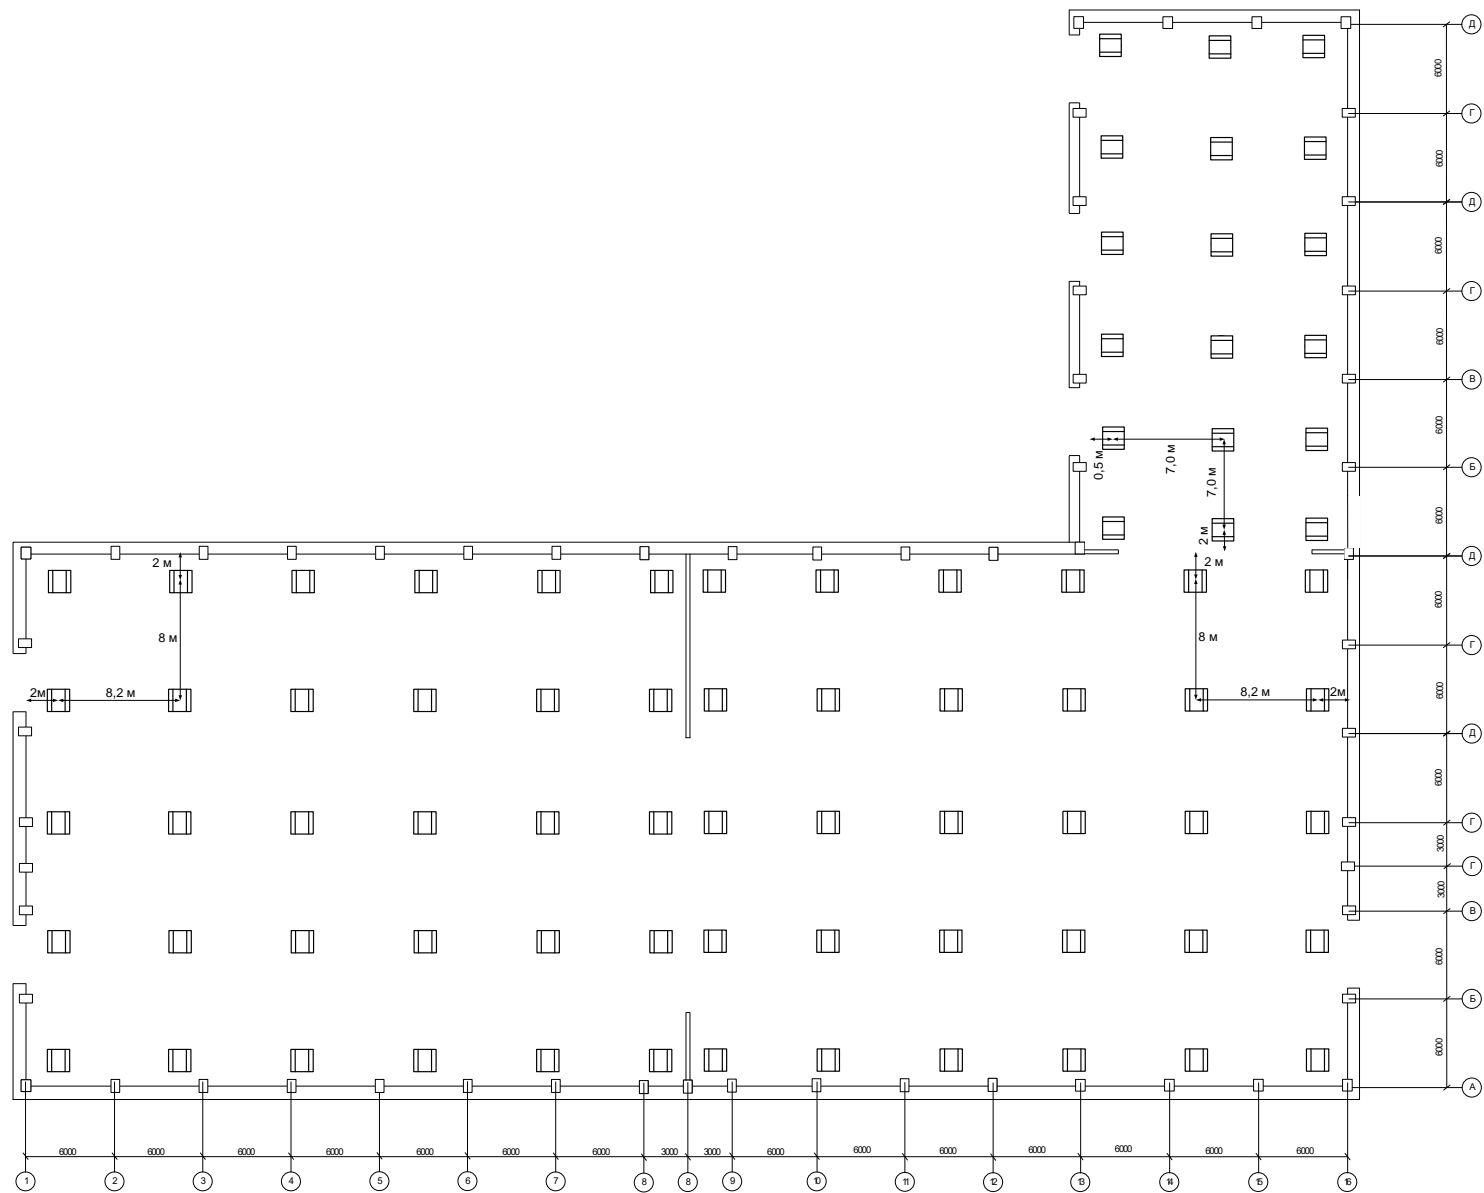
Размещение светильников на плане цеха (рабочее освещение)
